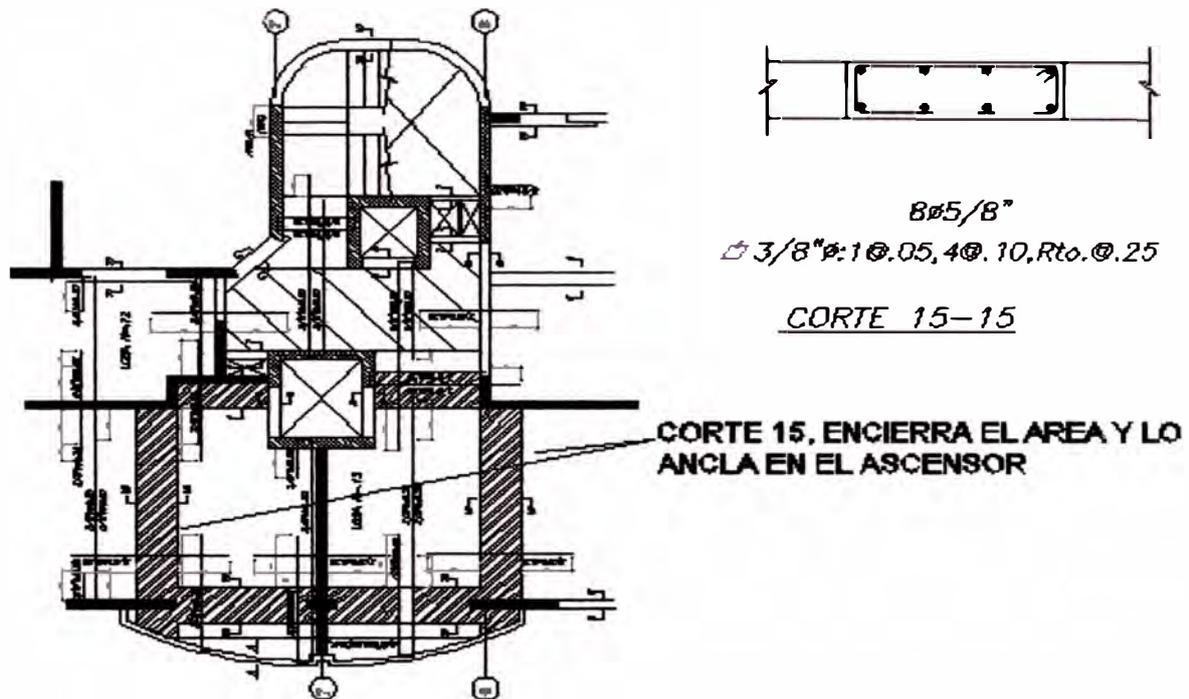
Detalle en planta de amarre de viga en losa. Ver E-05
